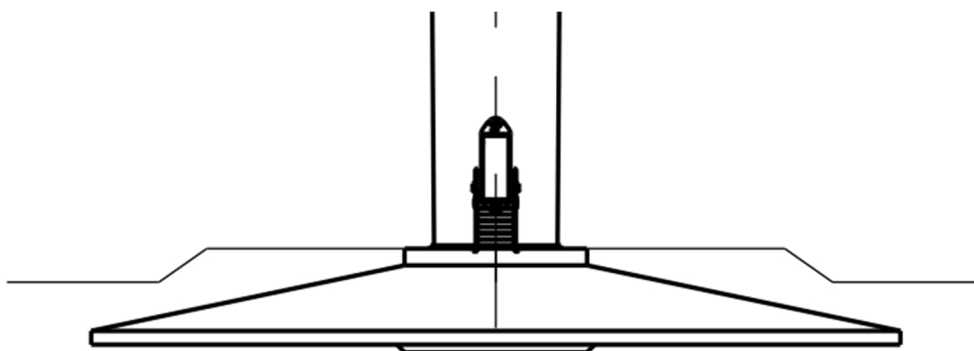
Schéma de la fondation d'une éolienne avec le niveau du sol apparent
